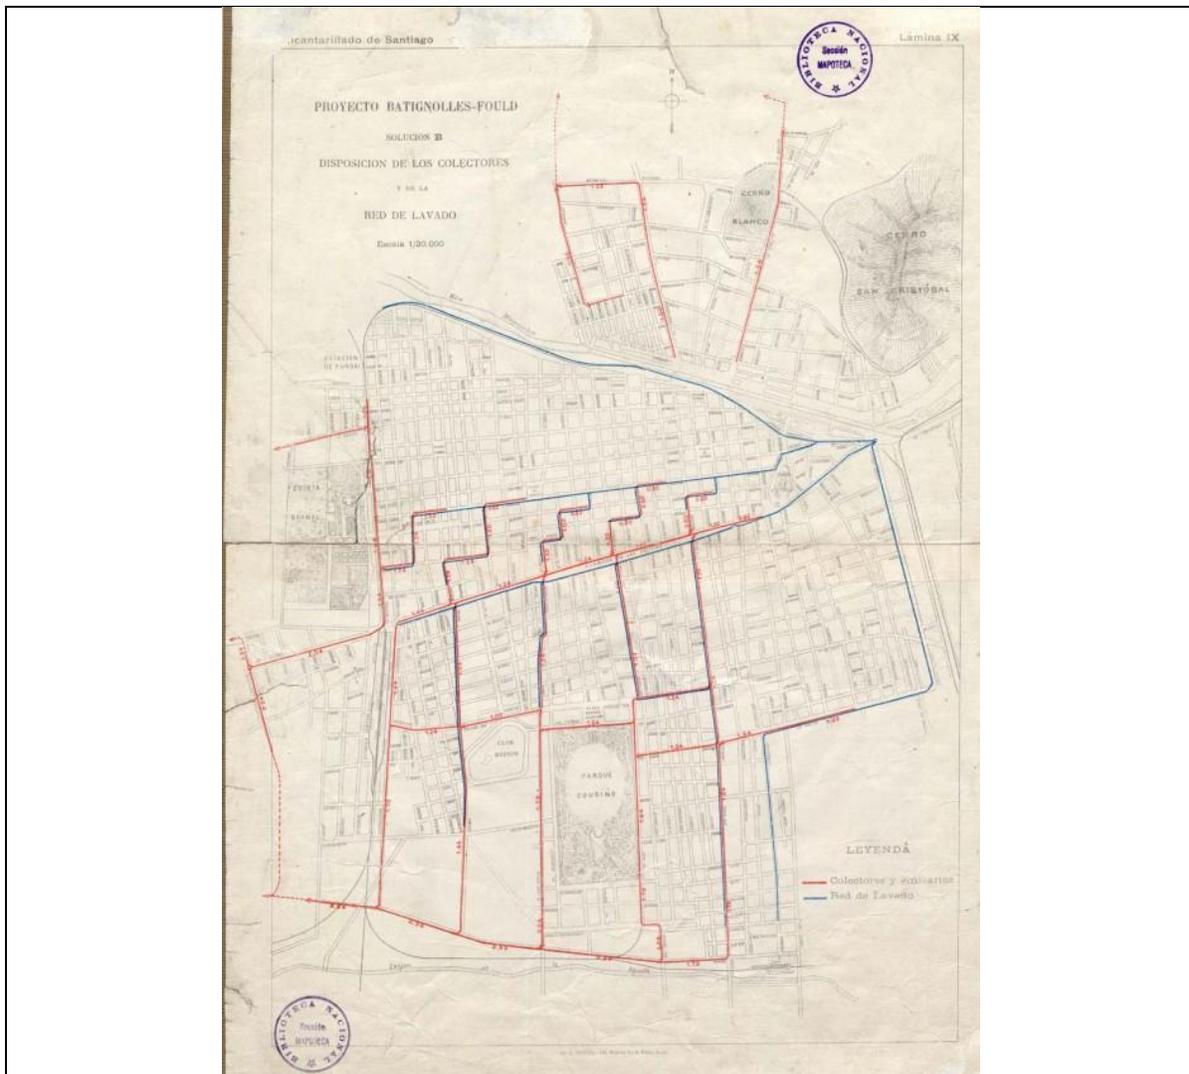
Alcantarillado de Santiago: proyecto Batignolles-Fould solución B : disposición de los colectores y de la red de lavado, 1904.
